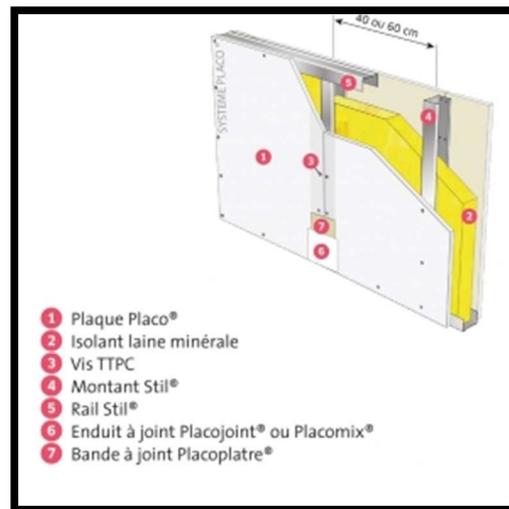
schéma détaillé d'un mur en Placoplatre.
